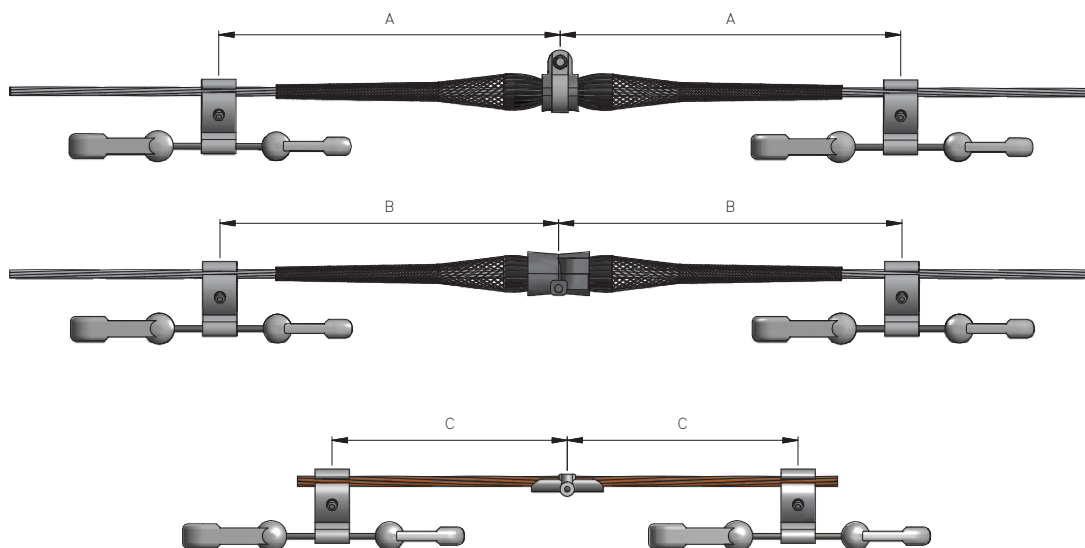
APLICAÇÃO EM ESTRUTURAS DE SUSPENSÃO
